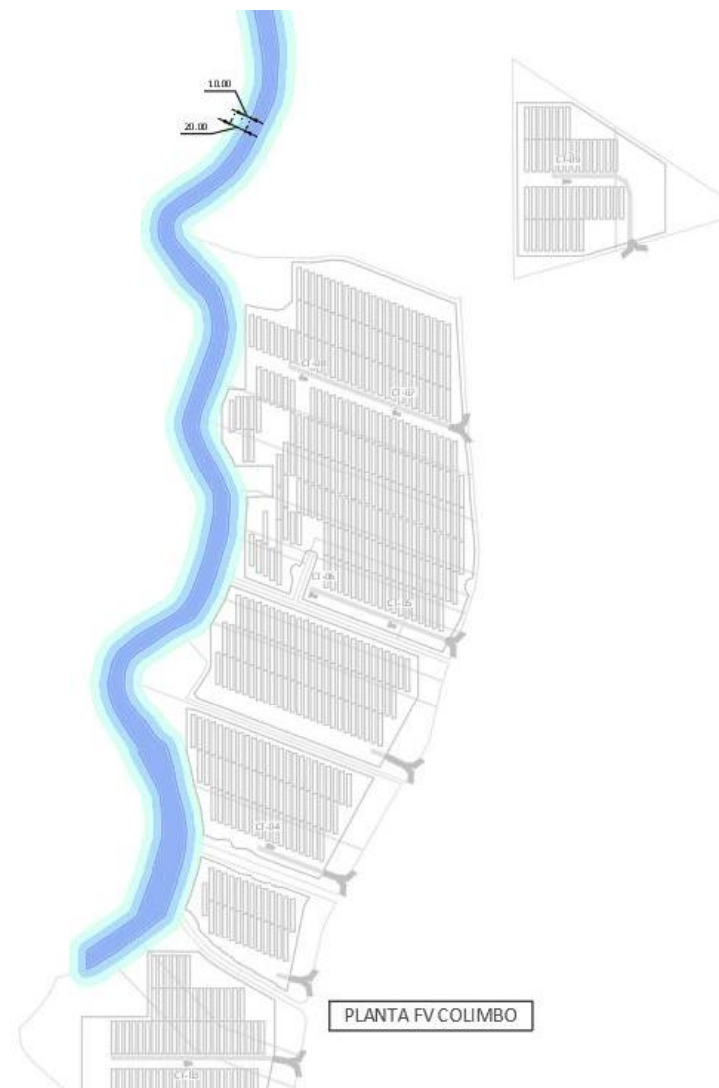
Infraestructura afectada por la planta fotovoltaica
